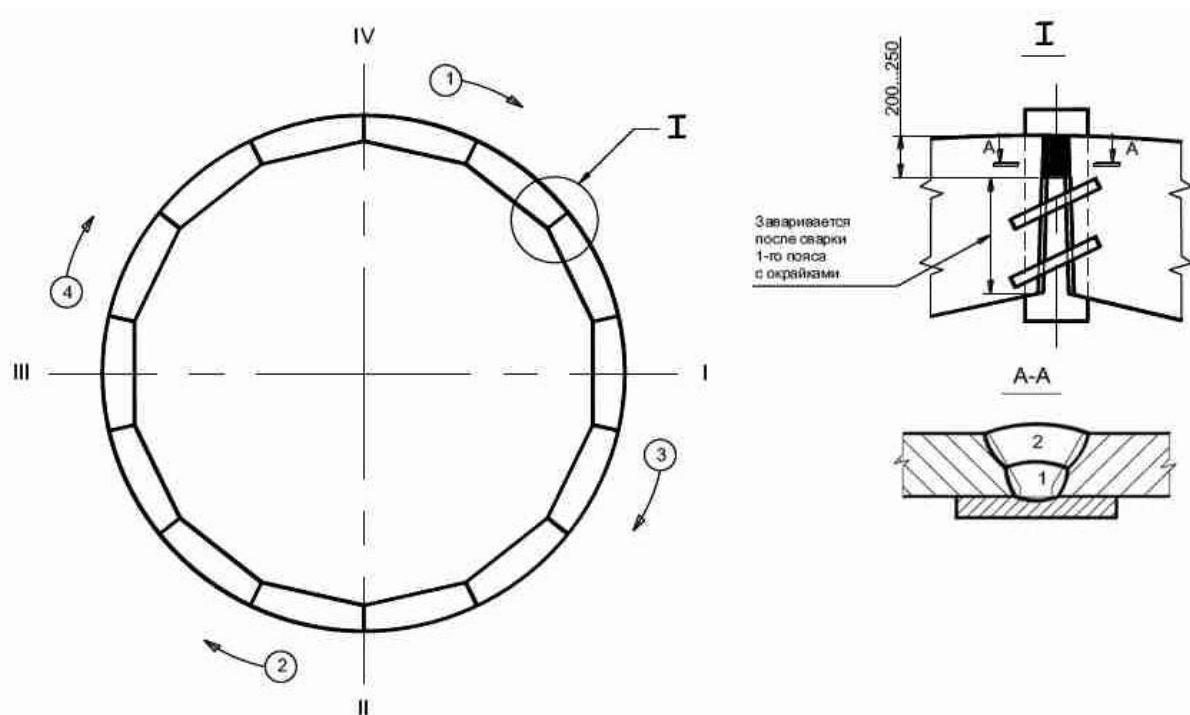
Схема выполнения сварных швов кольца окраск
